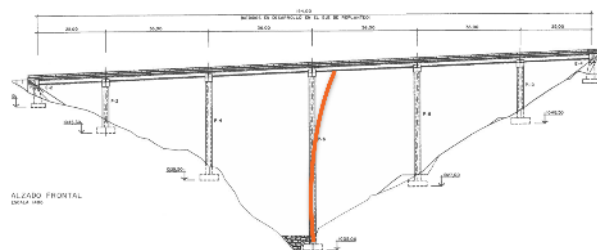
Situación del tablero topando en el estribo E-1 (estribo aguas abajo, Benavente).
